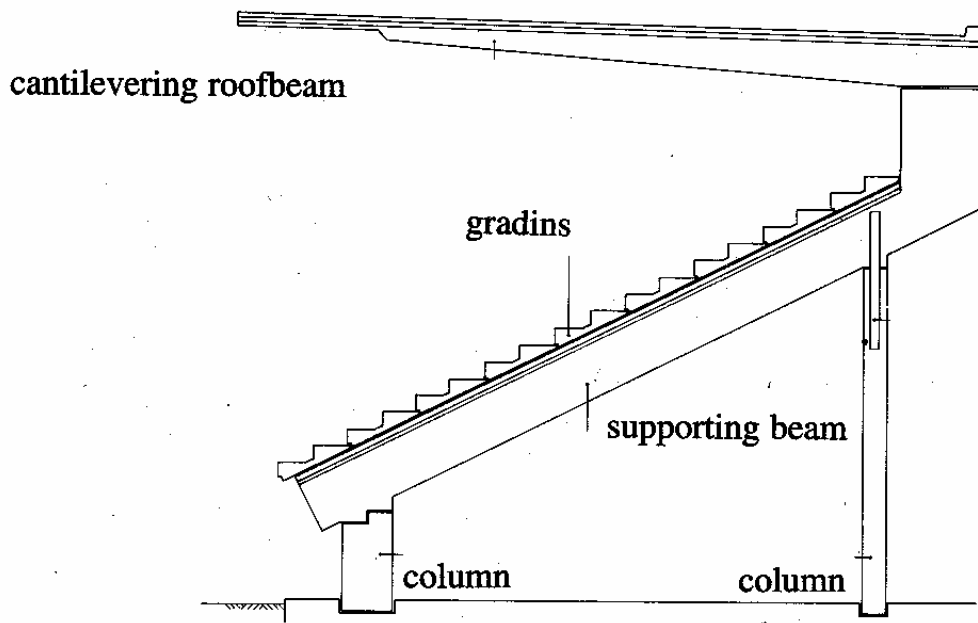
estrutura para arquivada em concreto pré-moldado
